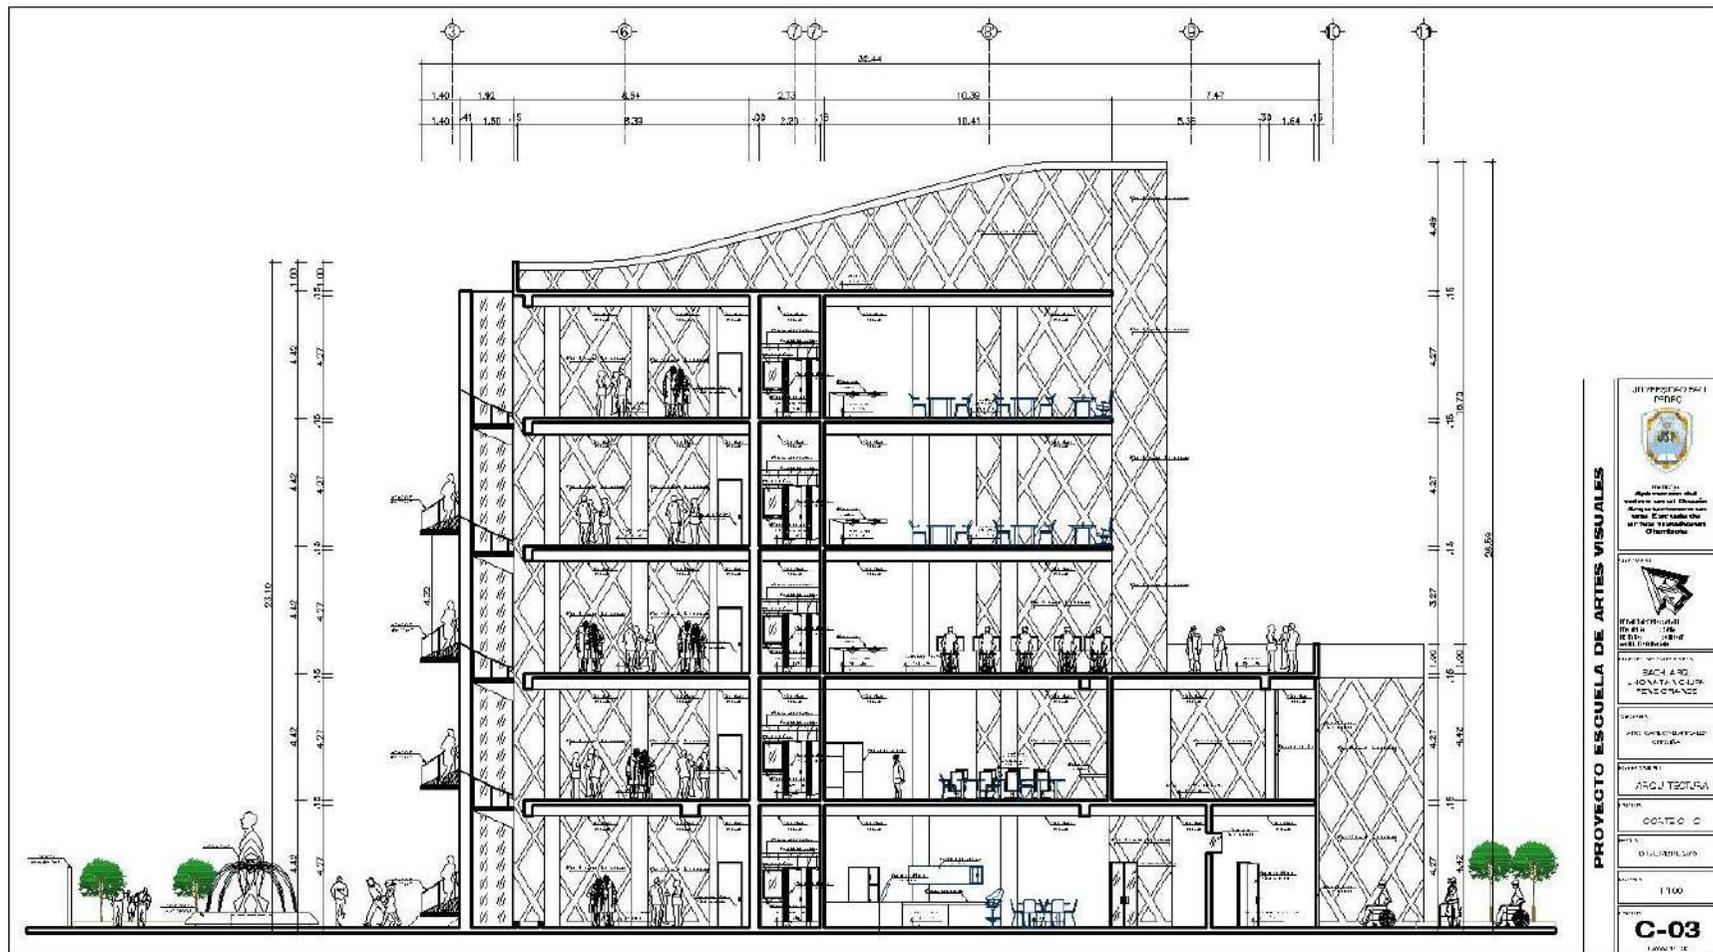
Plano de Corte C-C del Proyecto Arquitectónico
